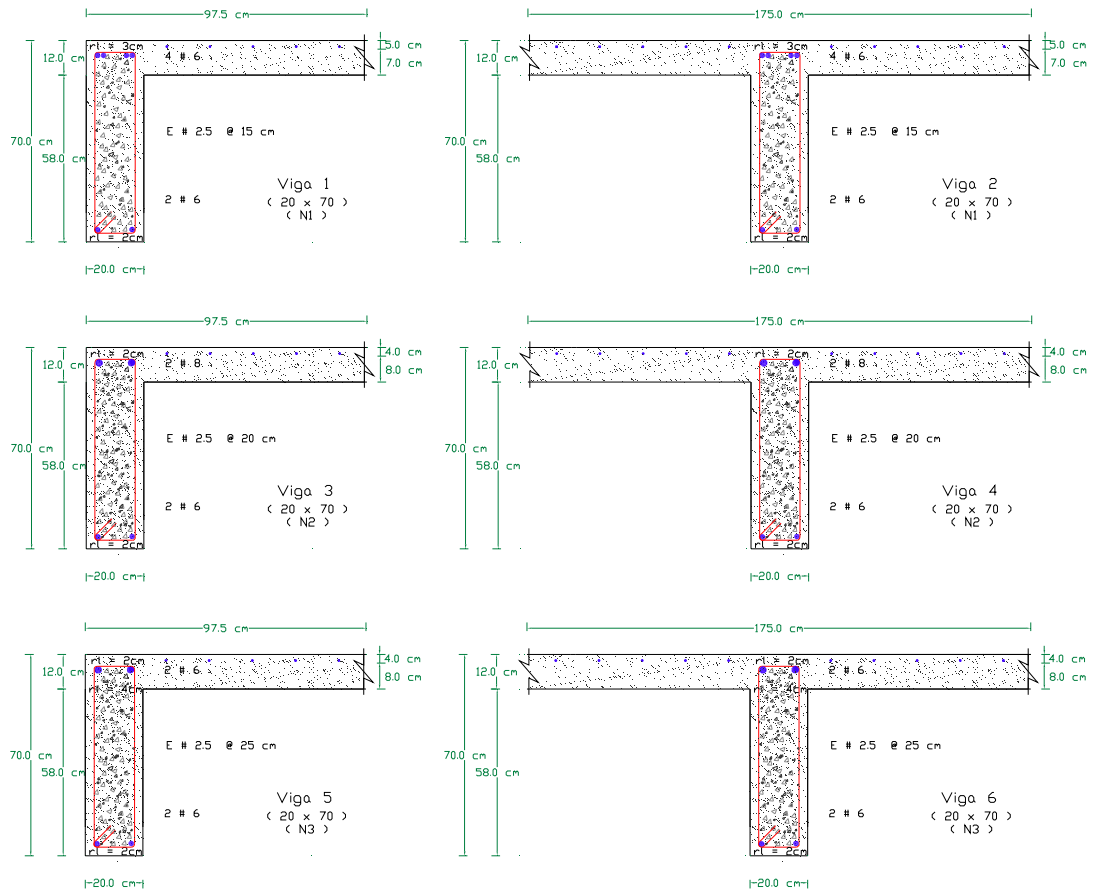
Dimensiones y armado de vigas, edificio I₃
